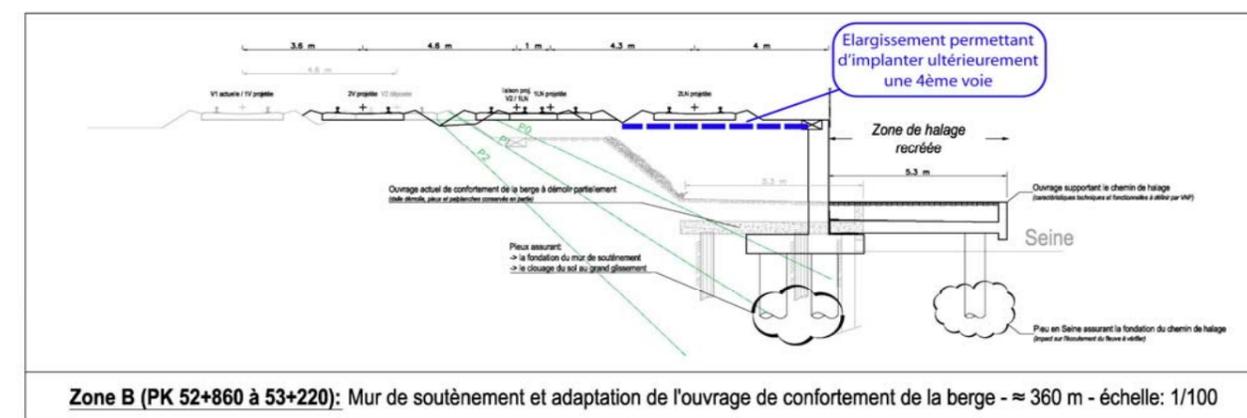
Coupe transversale, montrant l'élargissement s'appuyant sur un mur de soutènement et nécessitant l'adaptation de l'ouvrage de confortement des berges avec reconstitution à ce niveau du chemin de halage
